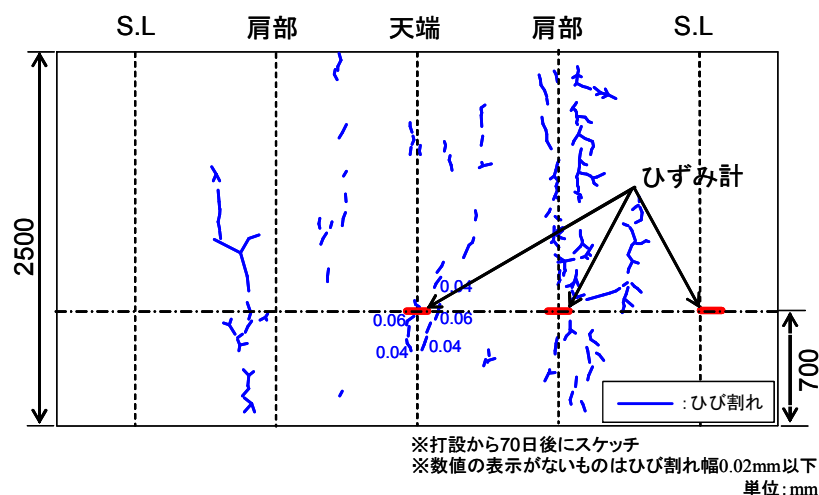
内空面ひび割れ展開図 (標準ケース (Case1))
